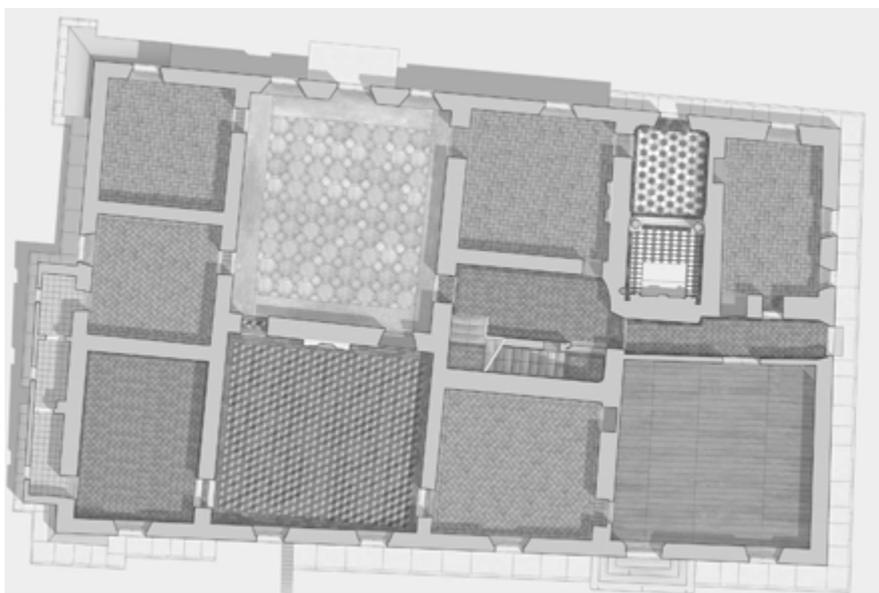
Pianta delle pavimentazioni del piano nobile della Villa
